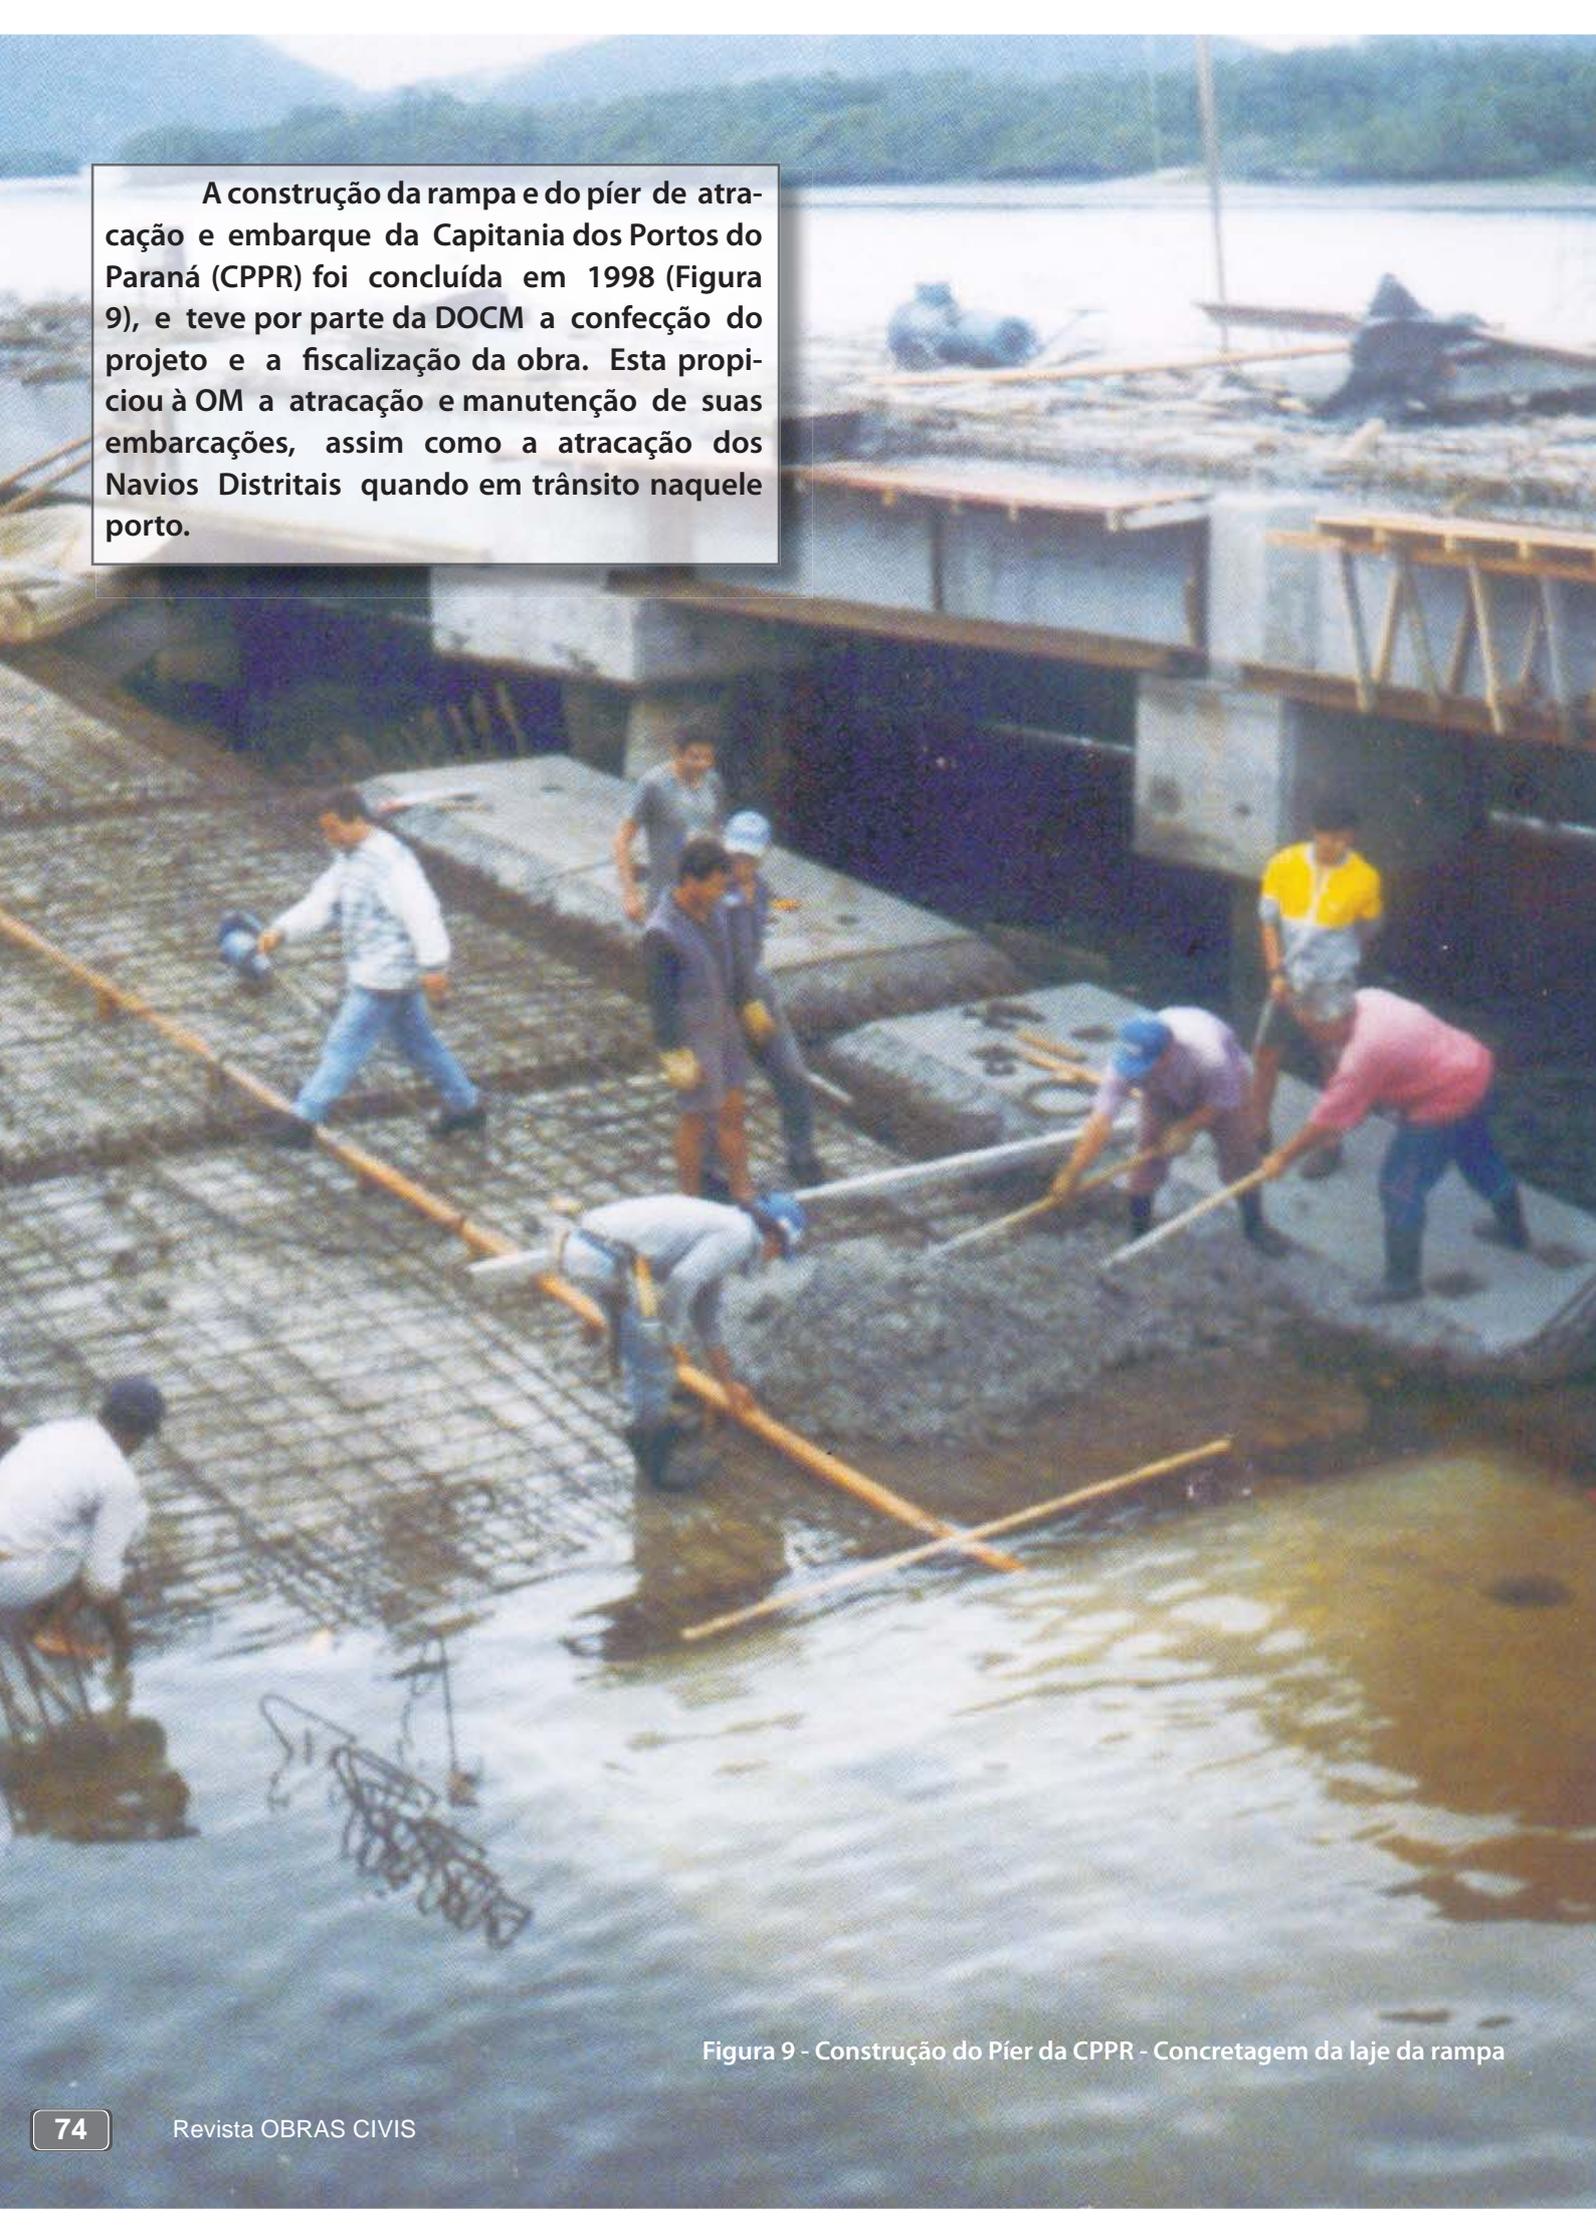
Construção do Píer da CPPR - Concretagem da laje da rampa
